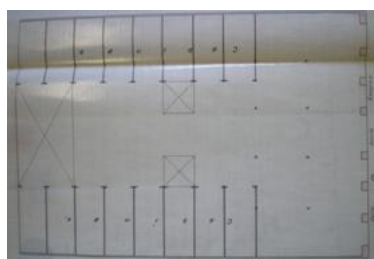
Distribución en Planta (zona patio de manzanas) del Garaje Plus Ultra.
